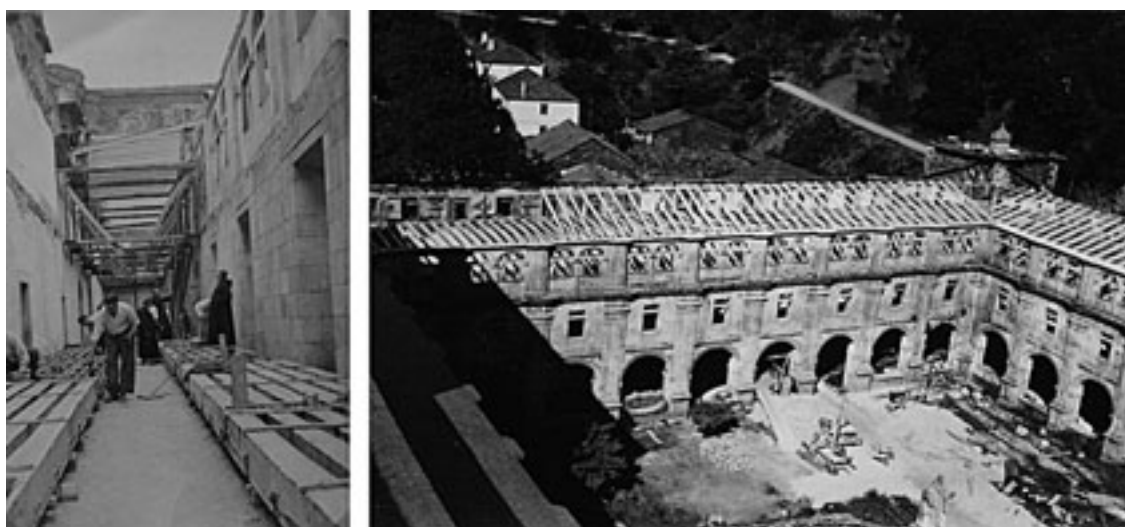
El proceso de reconstrucción de las estructuras de cubierta y de los forjados situados entre la primera y la segunda planta a través de nuevas estructuras de hormigón armado, 1953-1954. © Fondo Fotográfico del Monasterio de San Julián de Samos.
